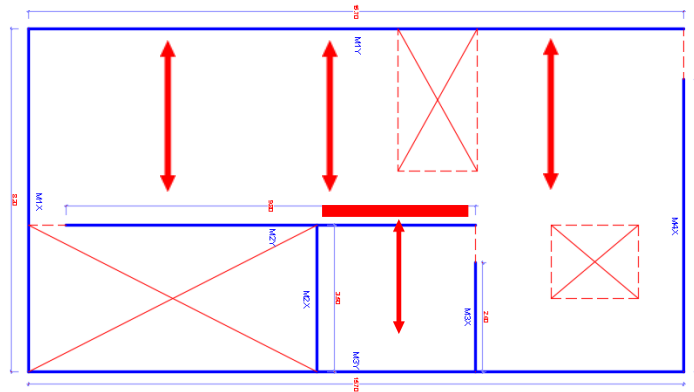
Direccionamiento de las losas aligeradas de 20 cm y muro más cargado axialmente (M2Y)
